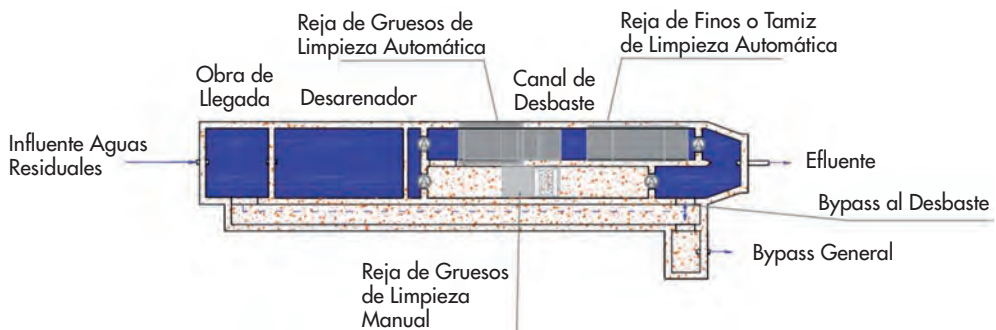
Planta de pretratamiento con tanque desarenador en cabecera
